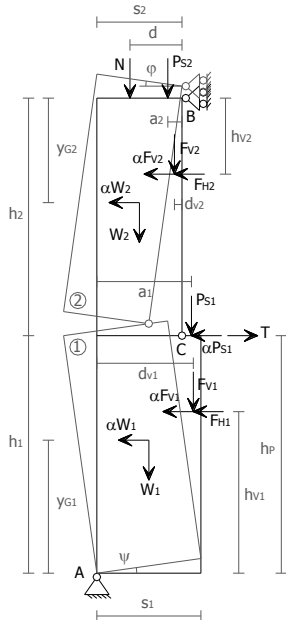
Schematizzazione di flessione verticale parete monolitica.
